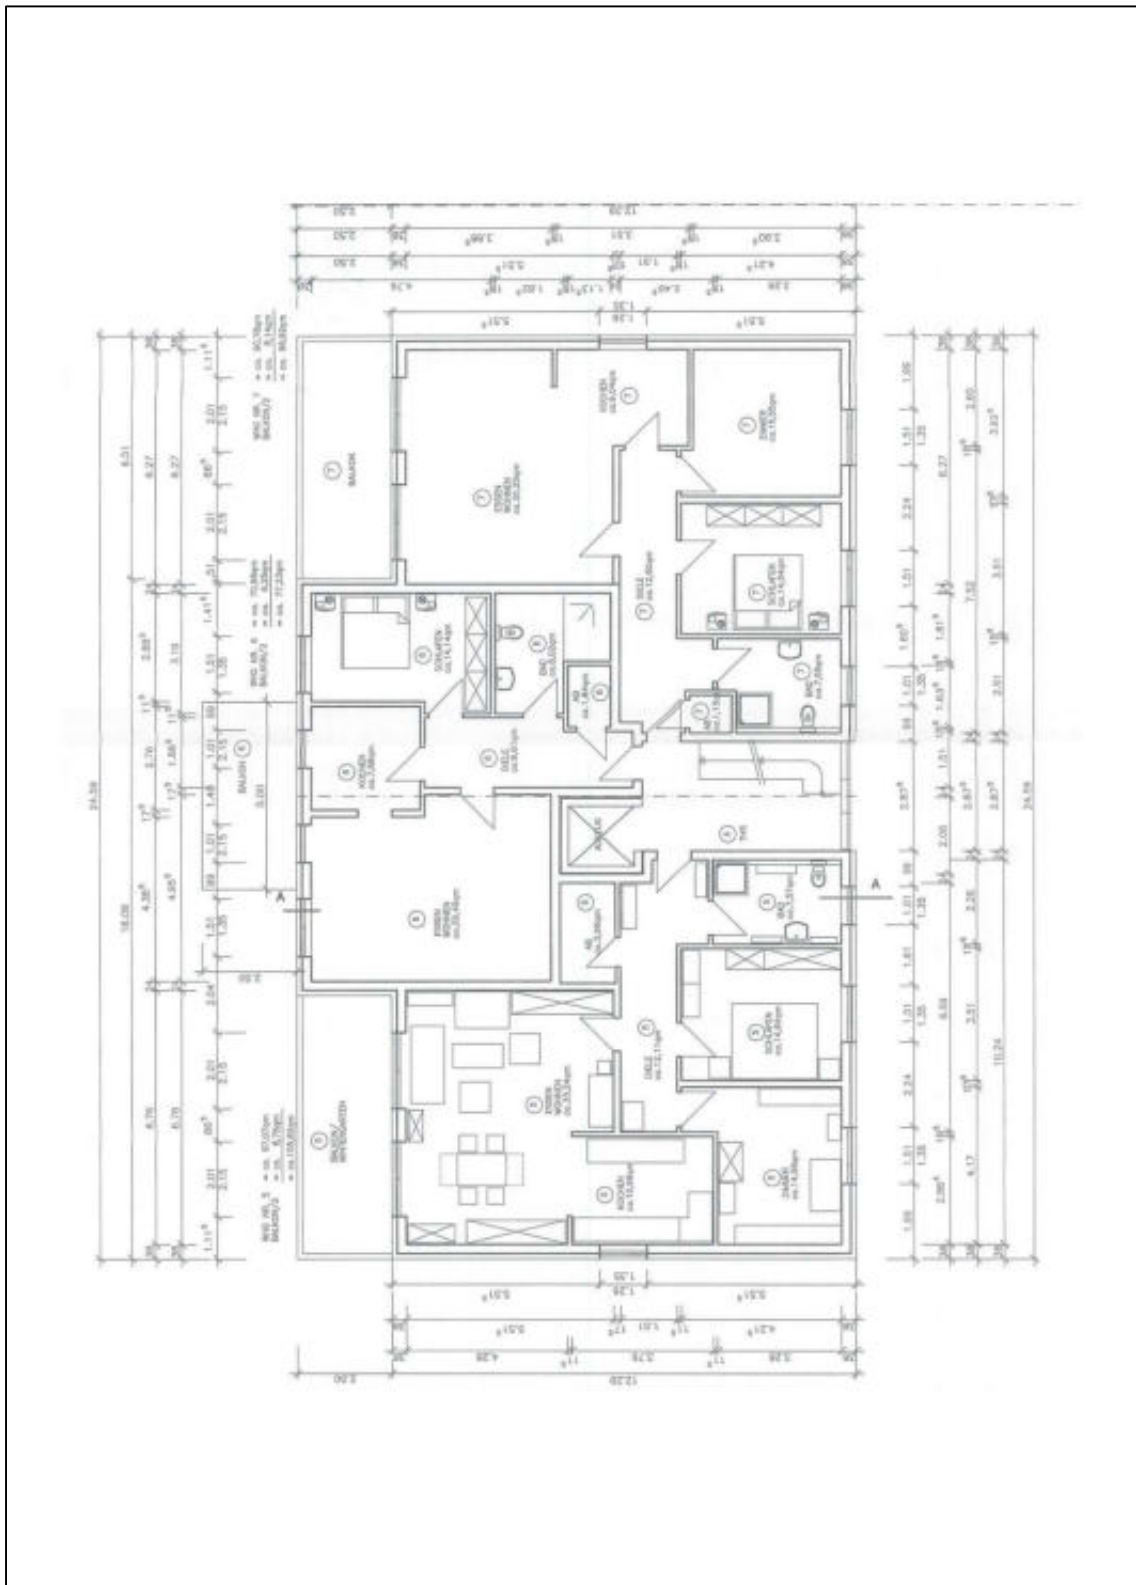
Grundriss vom 1. Obergeschoss
